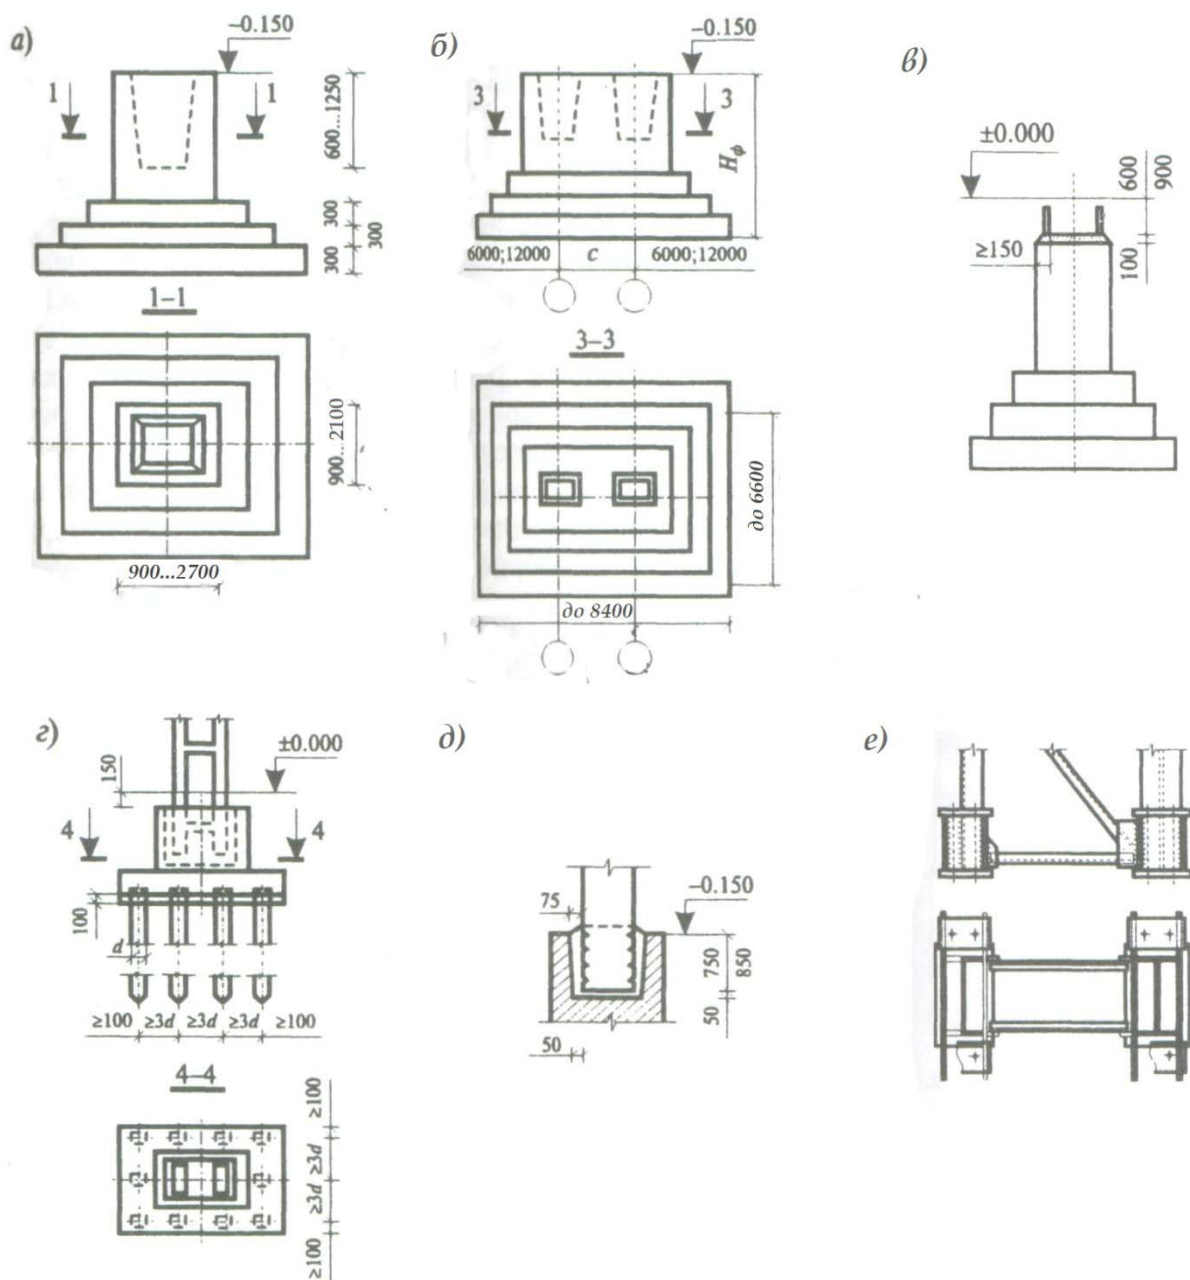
Фундаменты под железобетонные колонны: а – монолитные под рядовые железобетонные колонны; б – то же в местах устройства деформационных швов; в – фундамент под стальную колонну; г – свайный под двухветвевую железобетонную колонну; д – заделка железобетонной колонны в фундаменте; е – база двухветвевой стальной колонны
